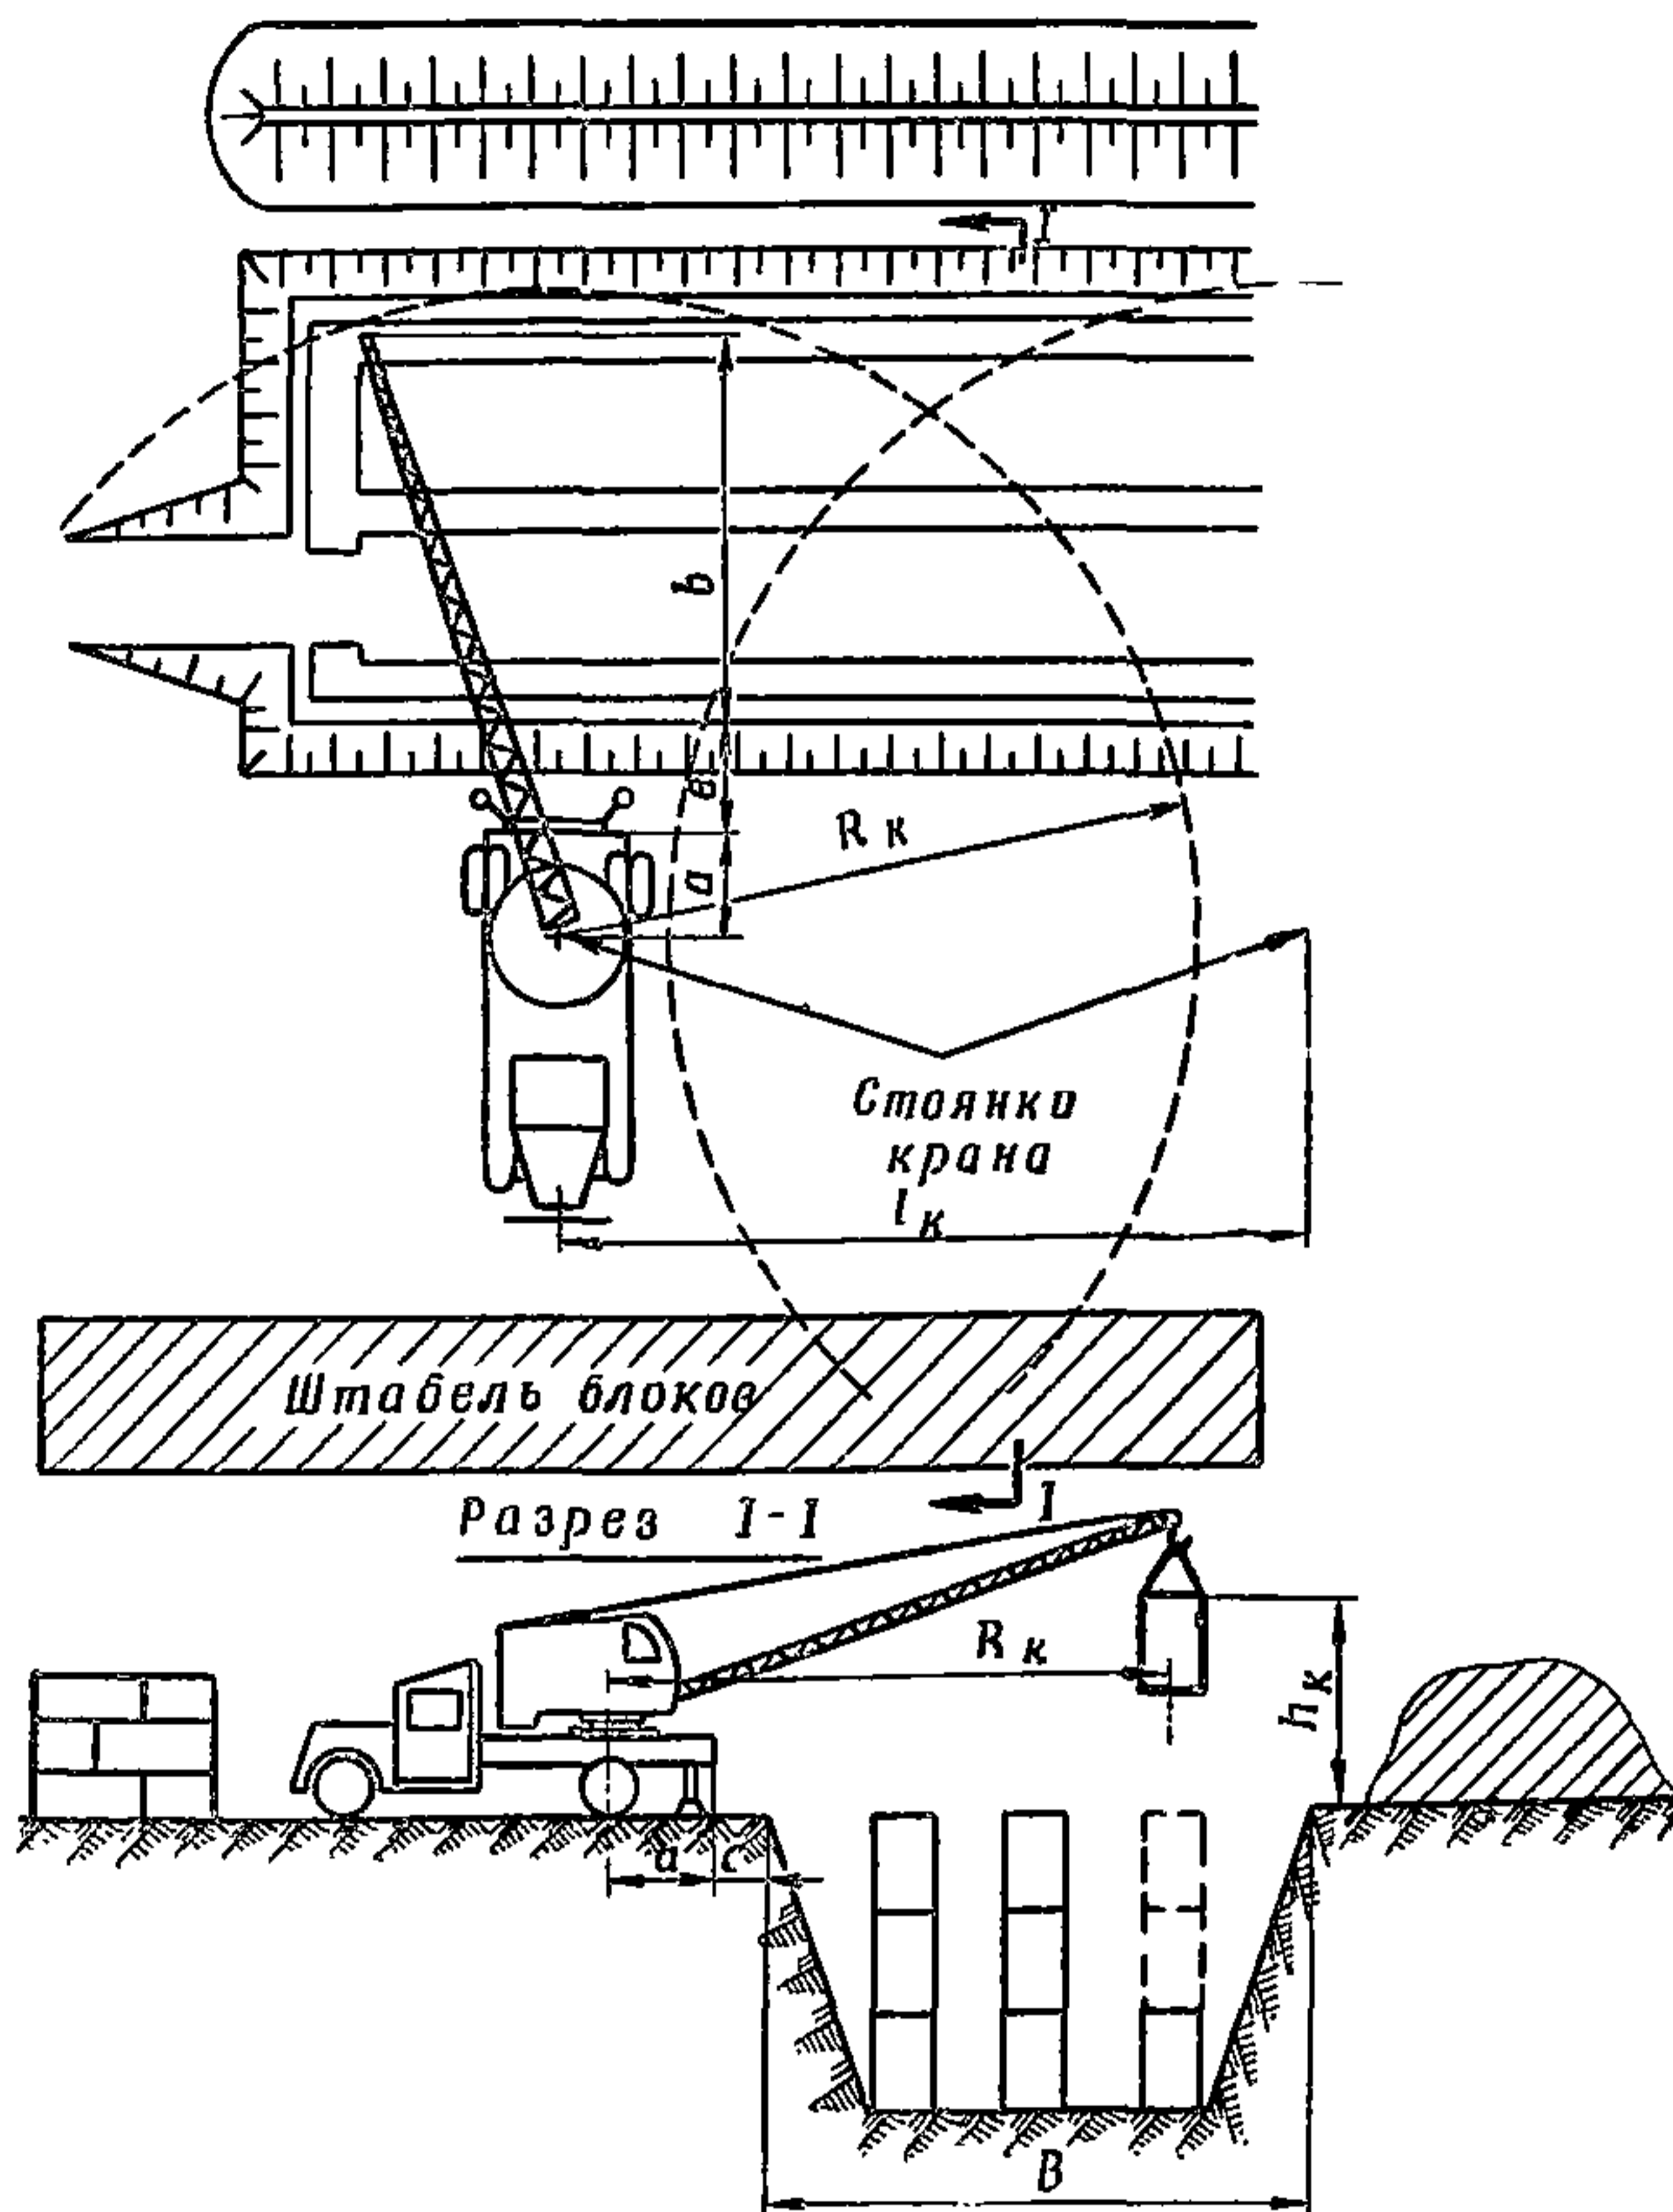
Схема производства работ по монтажу стен из крупных бетонных блоков с помощью автокрана:
